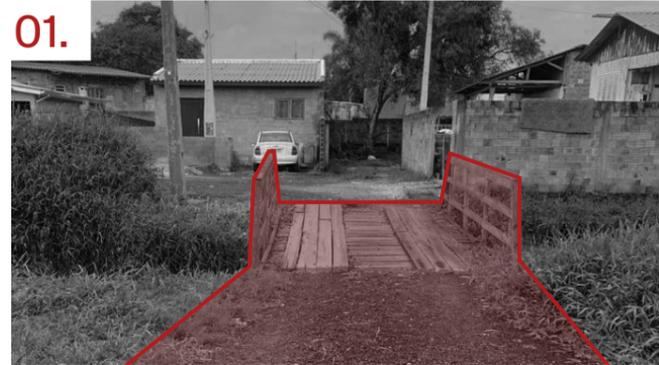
ponte em situação precária. fonte: arquivo pessoal
